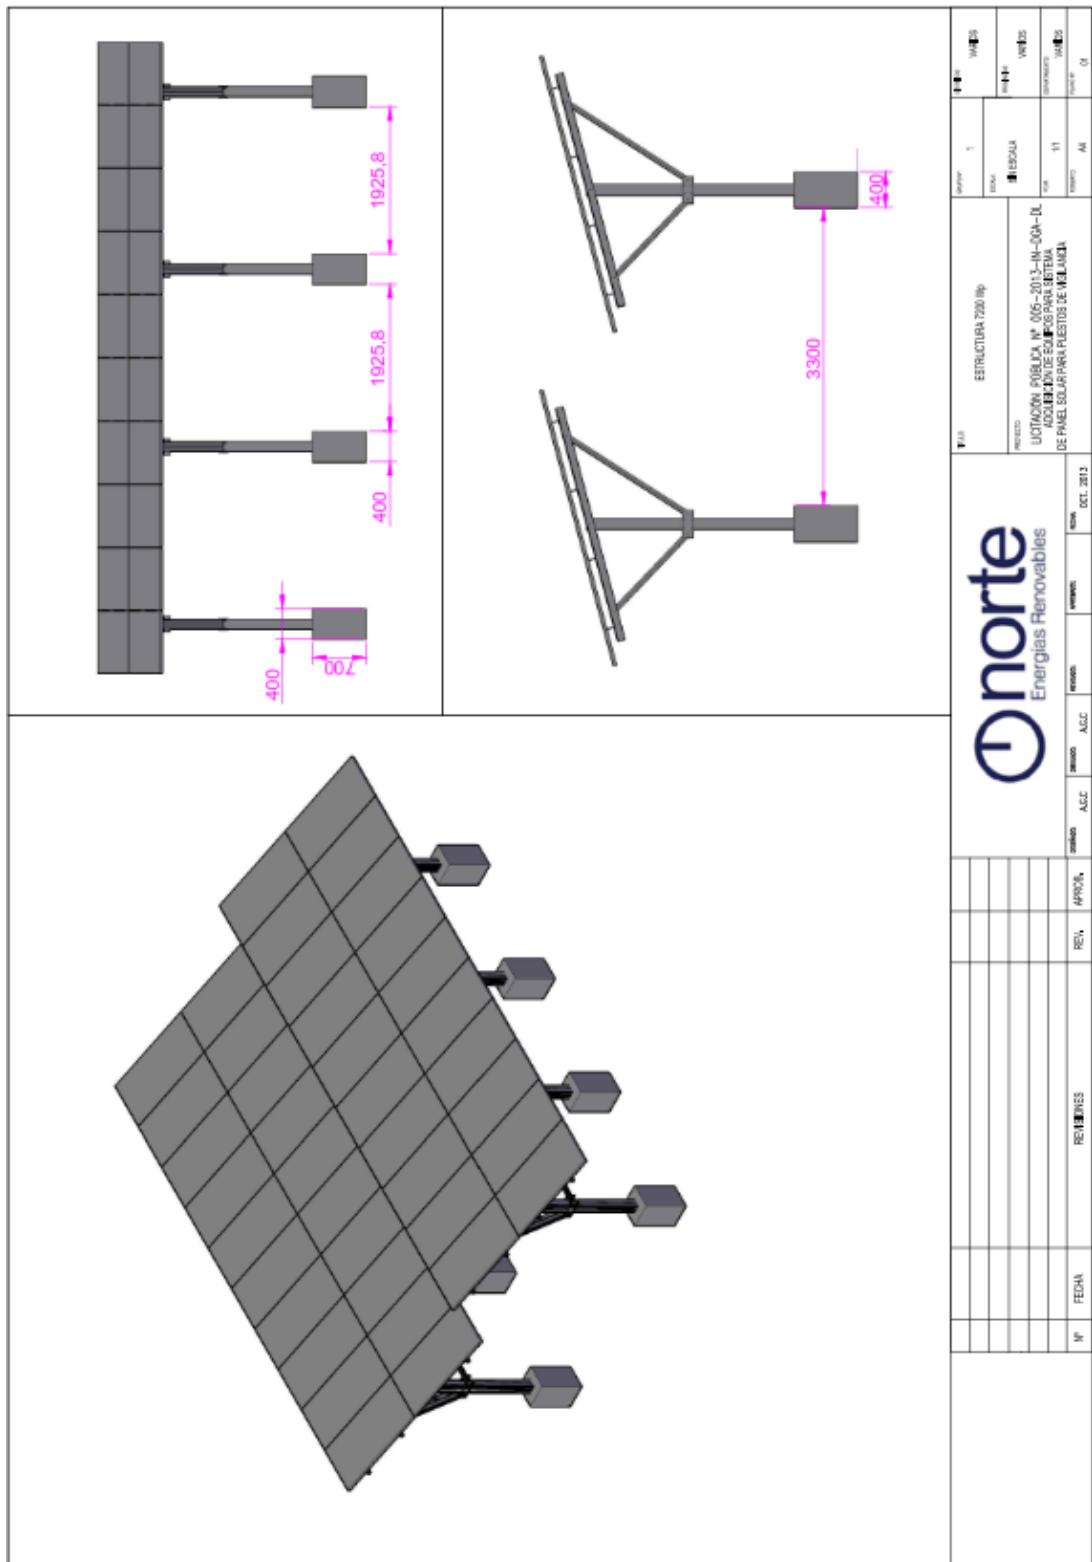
Plano de la estructura para el Sistema Fotovoltaico Instalado.
